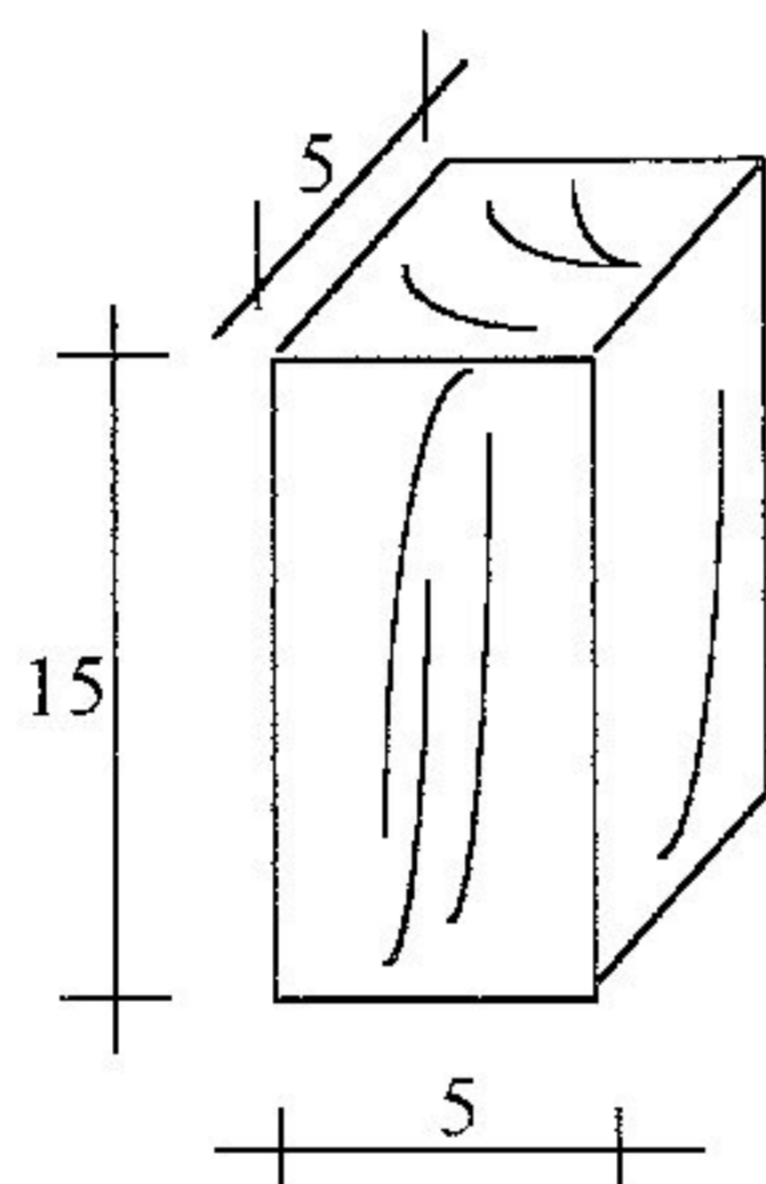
Corpo de Prova para Ensaio de Compressão Paralela (Dimensões em cm)
